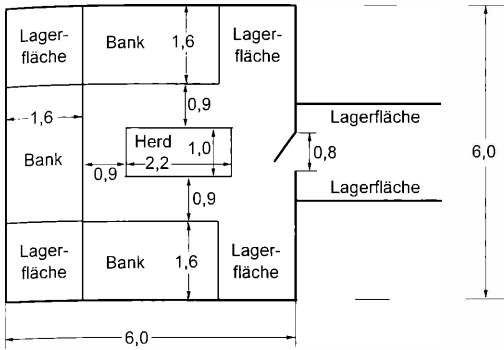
Grundriß einer traditionellen Winterjurte, Maßangaben in Meter, nach Schrenck (SCHRENCK 1891, 321 - 323).
